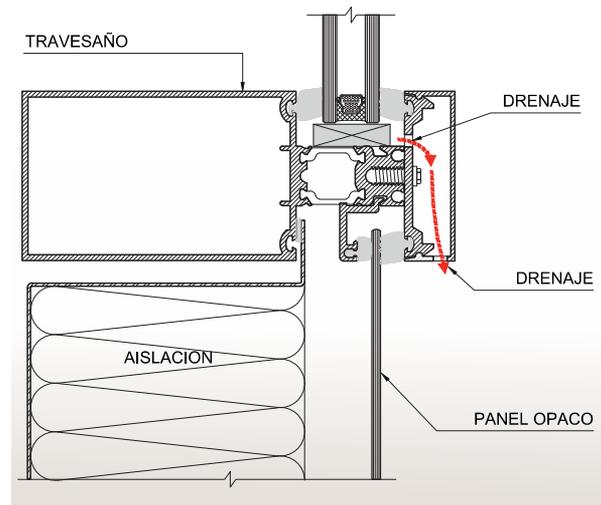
Sistema de drenaje de aguas lluvias de muro cortina.
